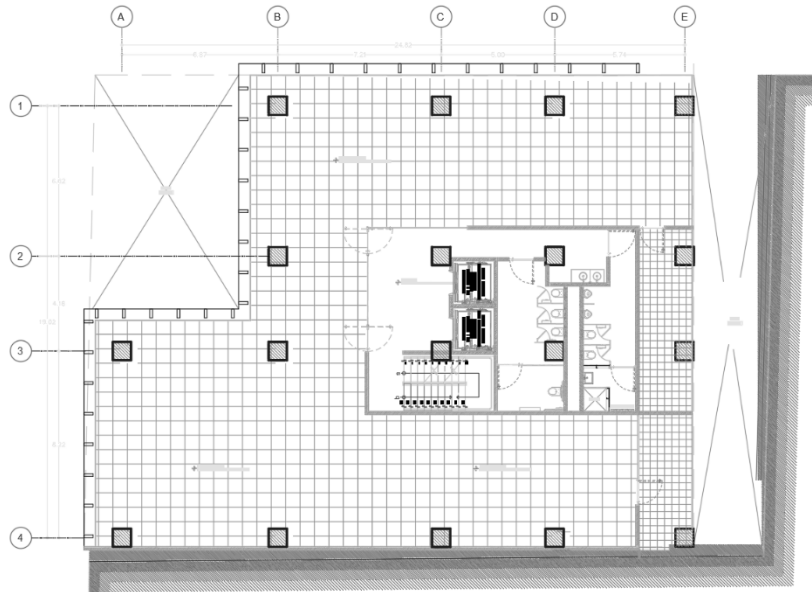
Planta de Ancho y Largo del Edificio.
